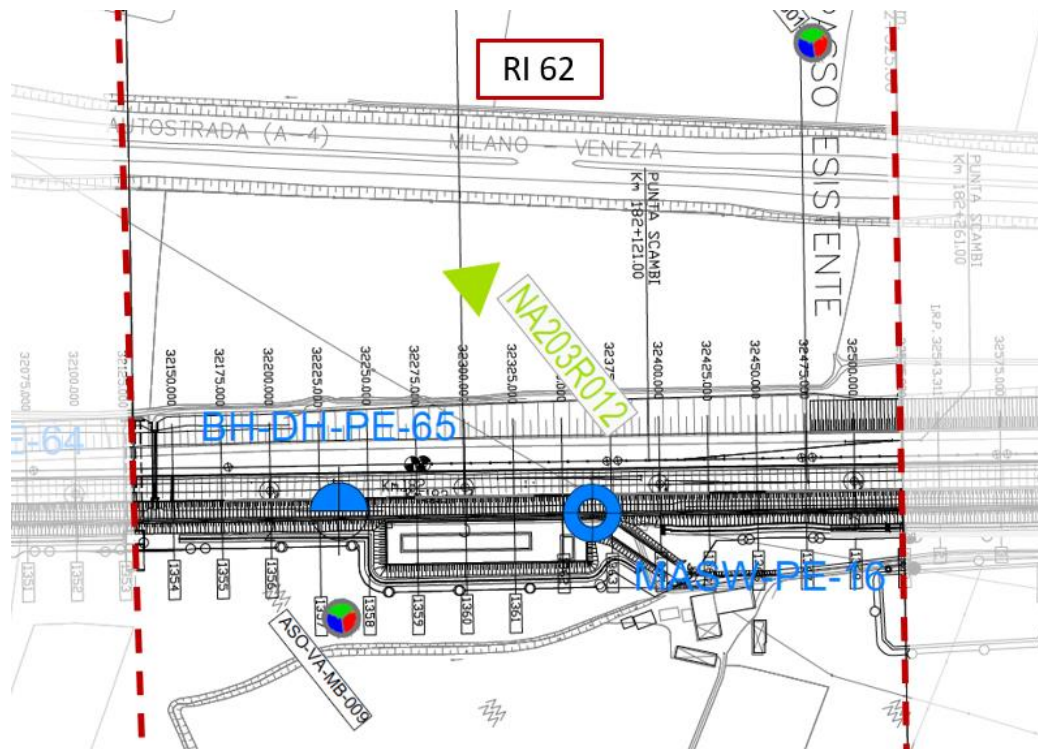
Planimetria Rilevato RI62, estratto dalla Planimetria Generale (Doc. Rif. [3])
